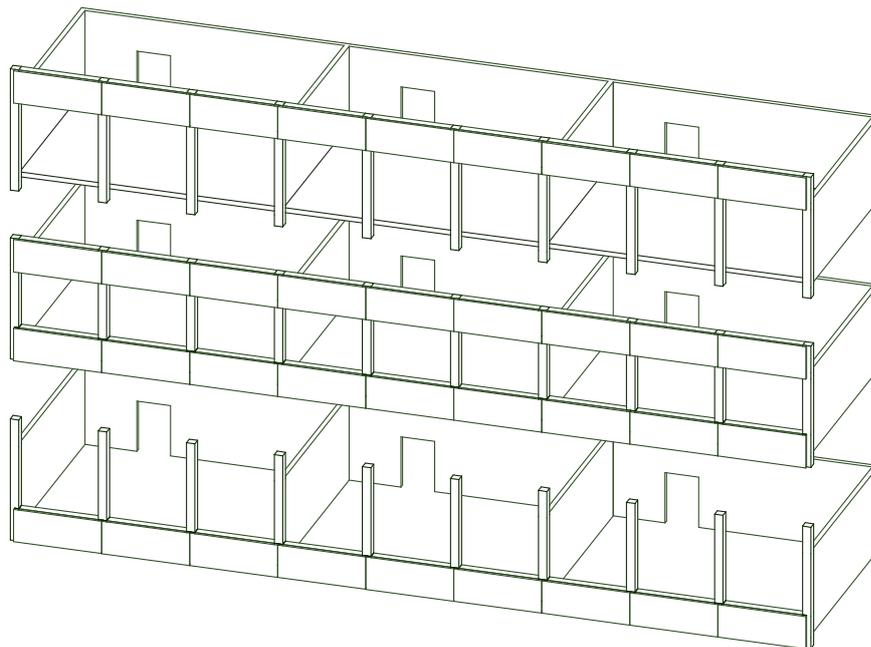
Grundsätzliche Brüstungs- und Sturzsituationen bei Bandfassaden (oben: FT B1, mittig: FT B2, unten: FT B3)
